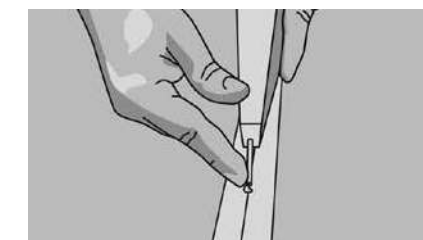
Всегда работайте двумя руками! Одной рукой держите тюбик, указательный палец второй руки положите на сопло. Вдавите иглу глубоко в шов так, чтобы холодная сварка попала в образовавшееся отверстие.
